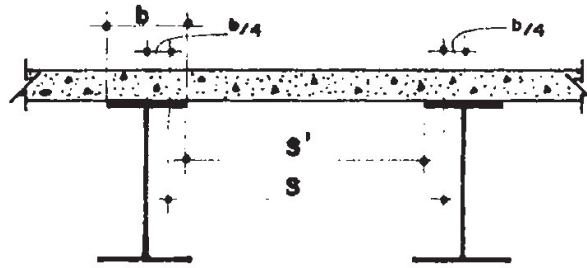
Losa apoyada sobre vigas metálicas.
